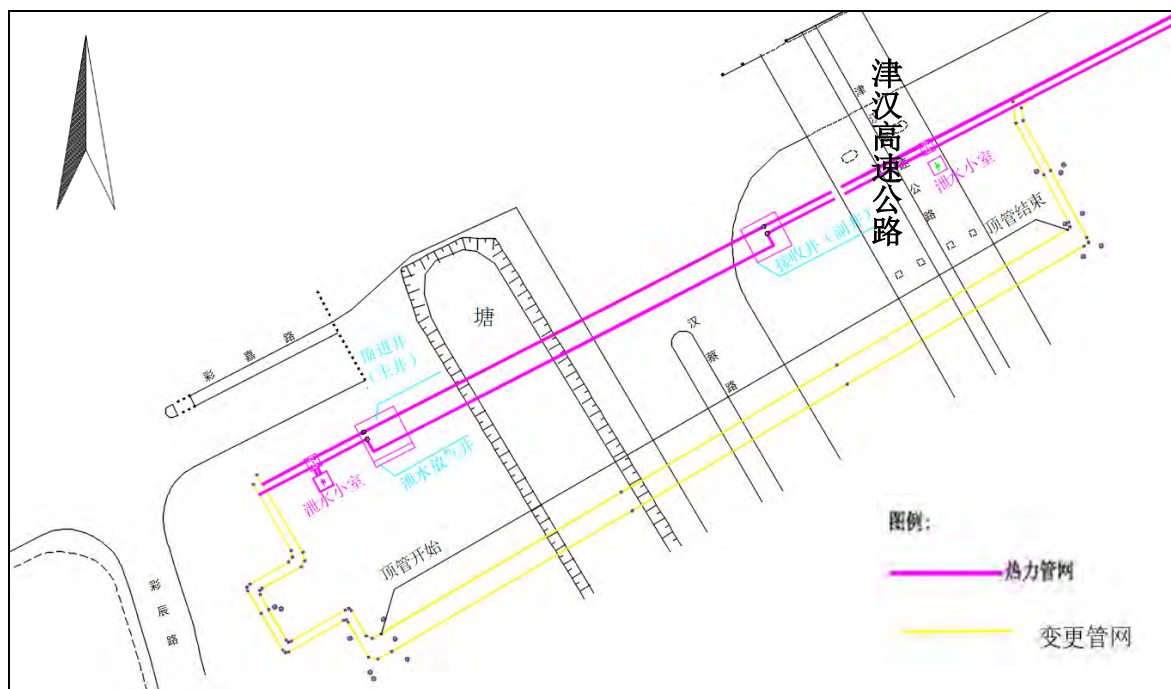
穿越津汉高速公路、汉蔡路热力管线变更平面图
